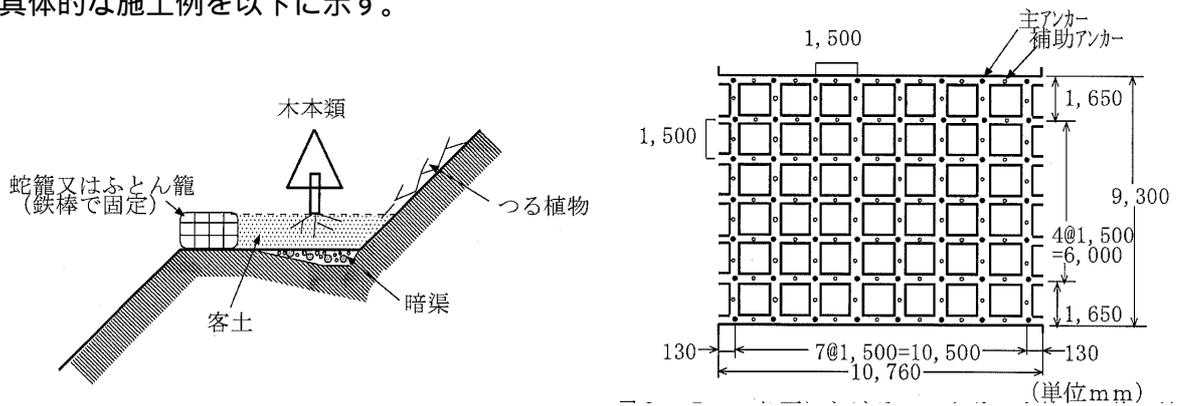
3 小段・のり面への緑化施工法 および のり面におけるコンクリート砕工の施工法
